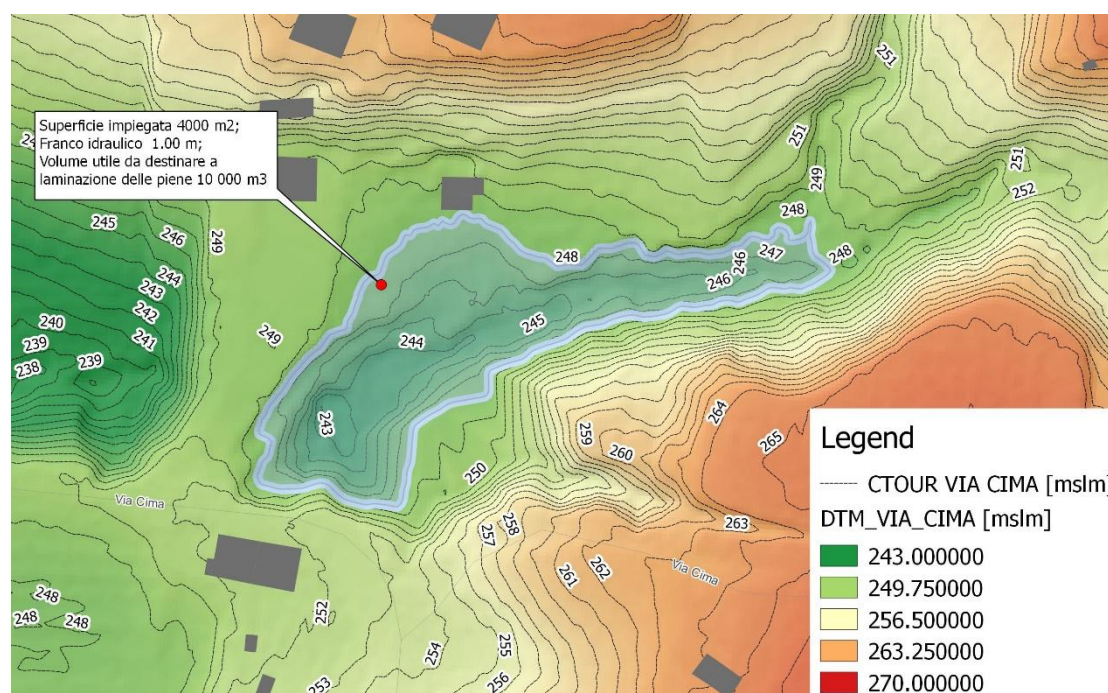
Planimetria del possibile bacino di laminazione riempito fino alla quota di massimo invaso (248 mslm)
